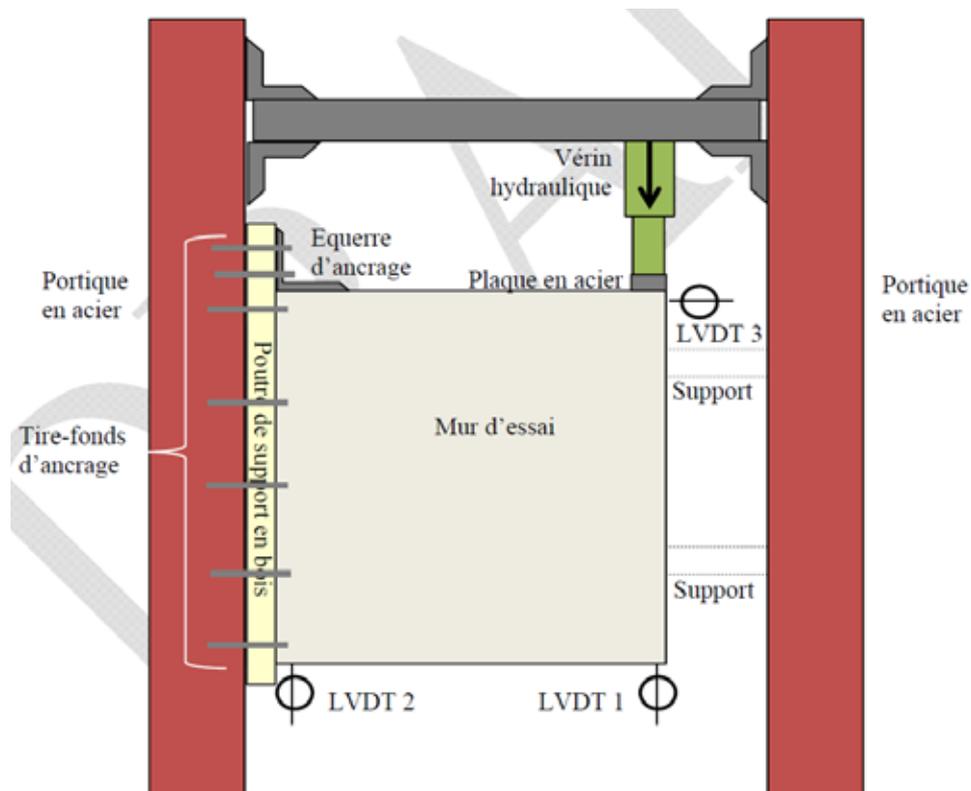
SCHÉMATISATION DU POSTE D'ESSAI DE CONTREVENTEMENT (VUE EN PLAN) [9]
